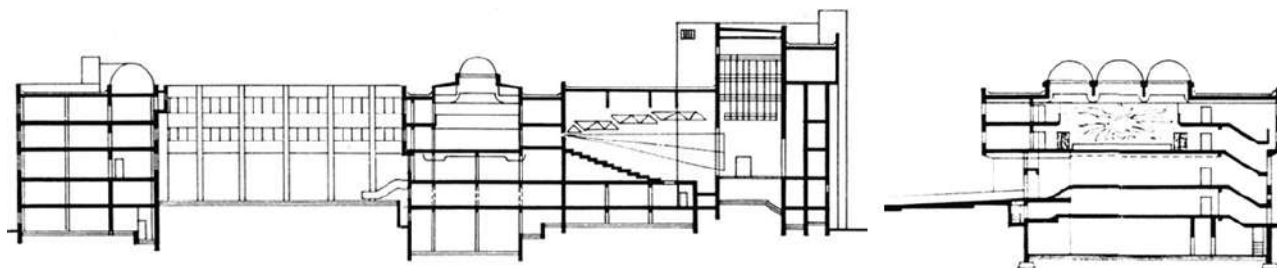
Поздовжній та поперечний перерізи будівлі
